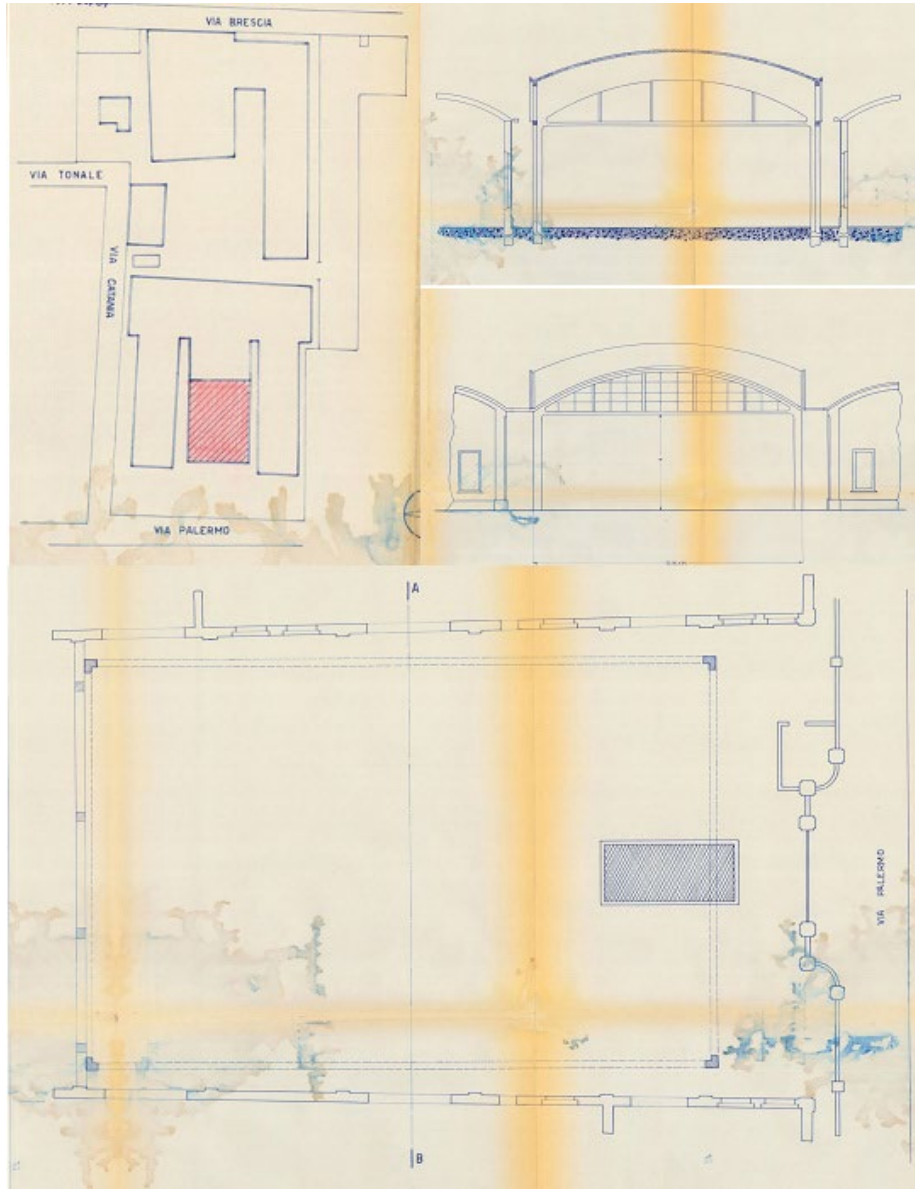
Oggetto: progetto di copertura del cortile esterno dello stabilimento: Padiglione Nervi.
